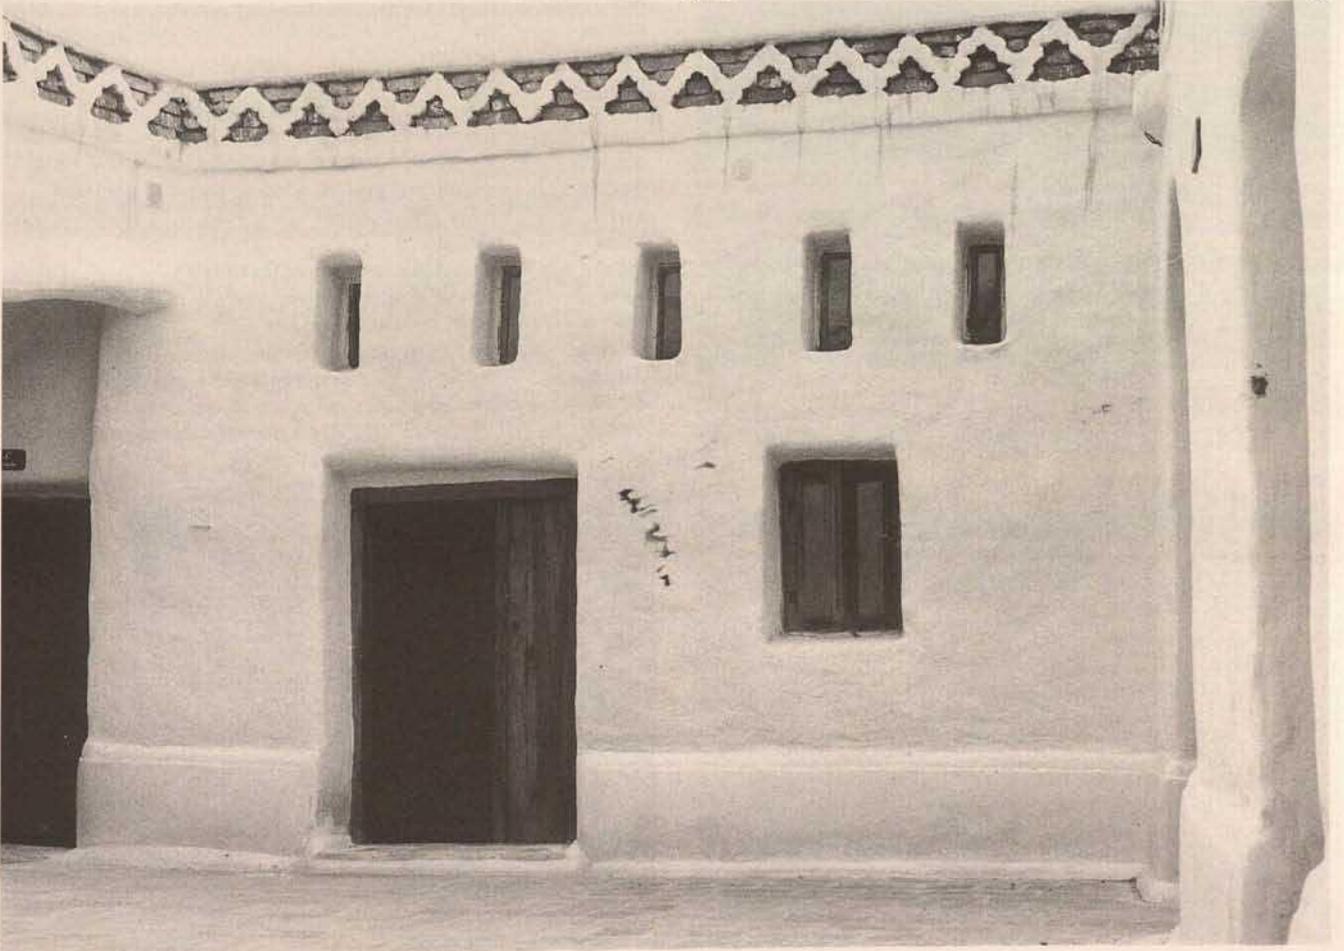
Nach Teilabriß und Wiedererrichtung des Ziegelmauerwerks mit vorhandenen Ziegeln
